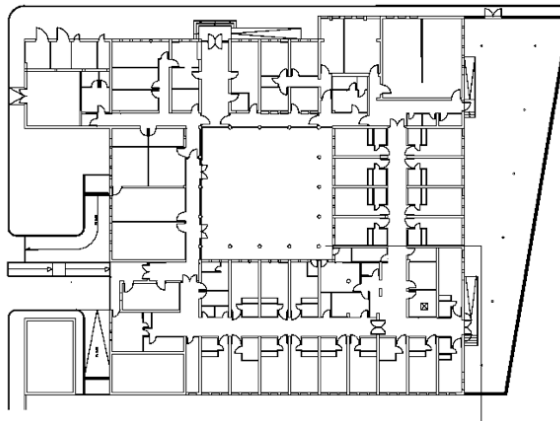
Plano de la planta baja del HMI donde se aprecia su planta rectangular con la continuidad entre ambas alas del edificio.
